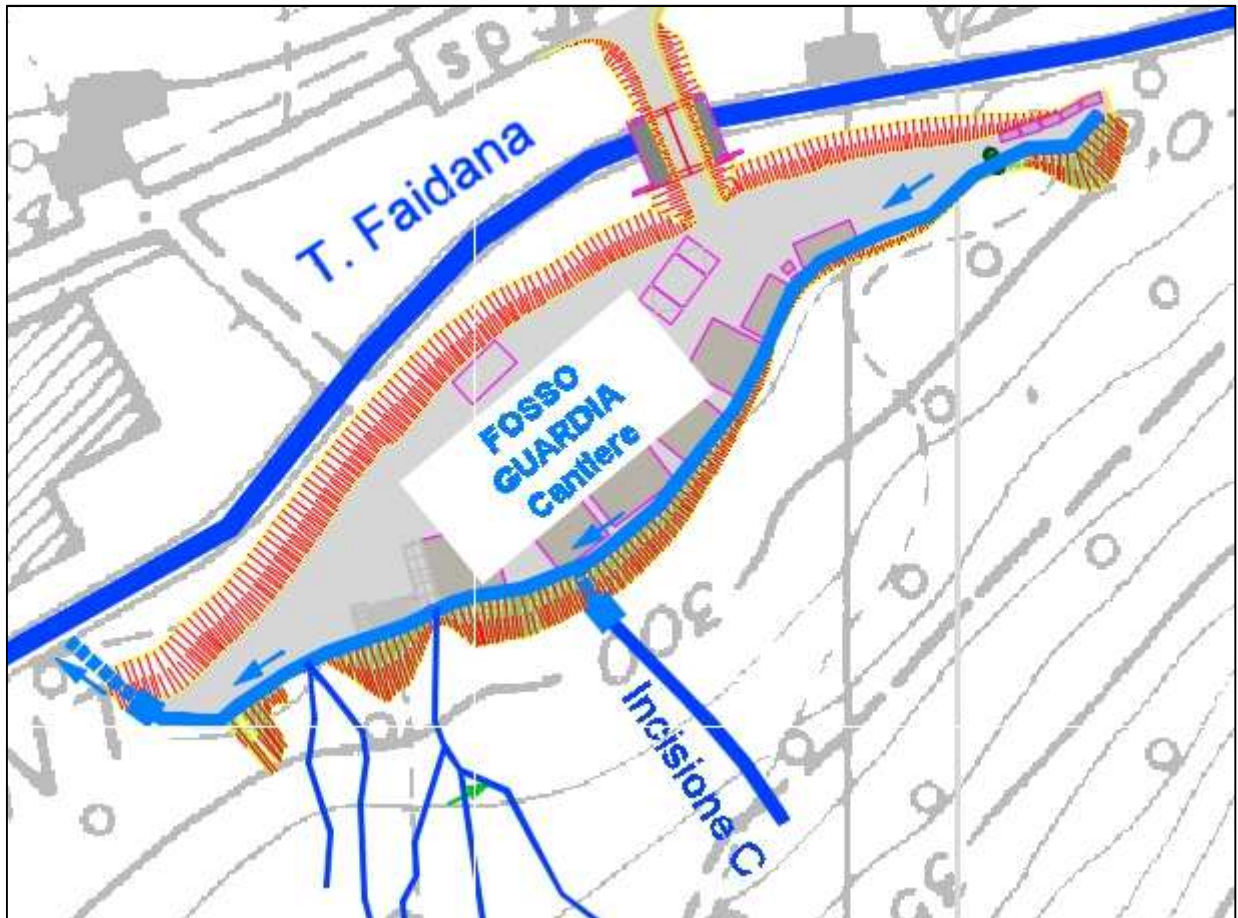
Canale guardia cantiere – Individuazione linee drenaggio (ante realizzazione delle viabilità principali e secondarie)
